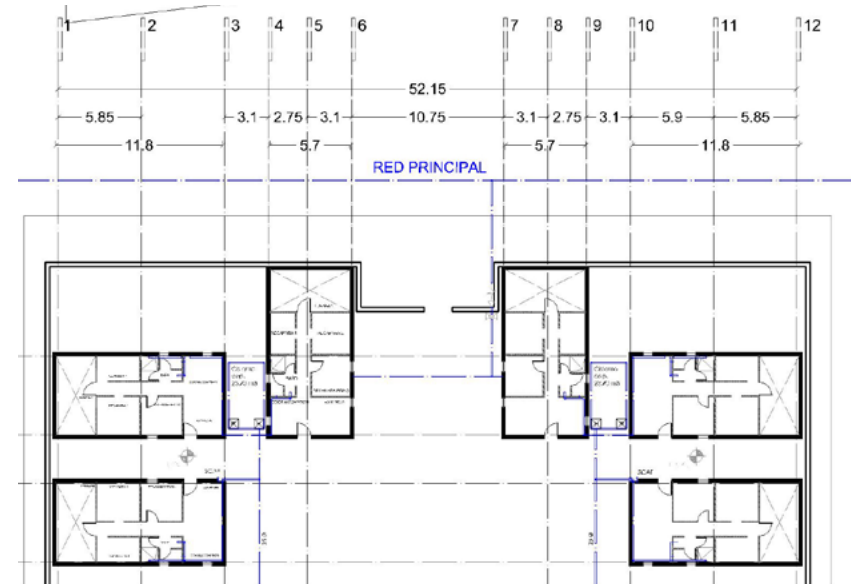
Ubicación de Registros, Planta Baja (NTP +0.20 mts)
